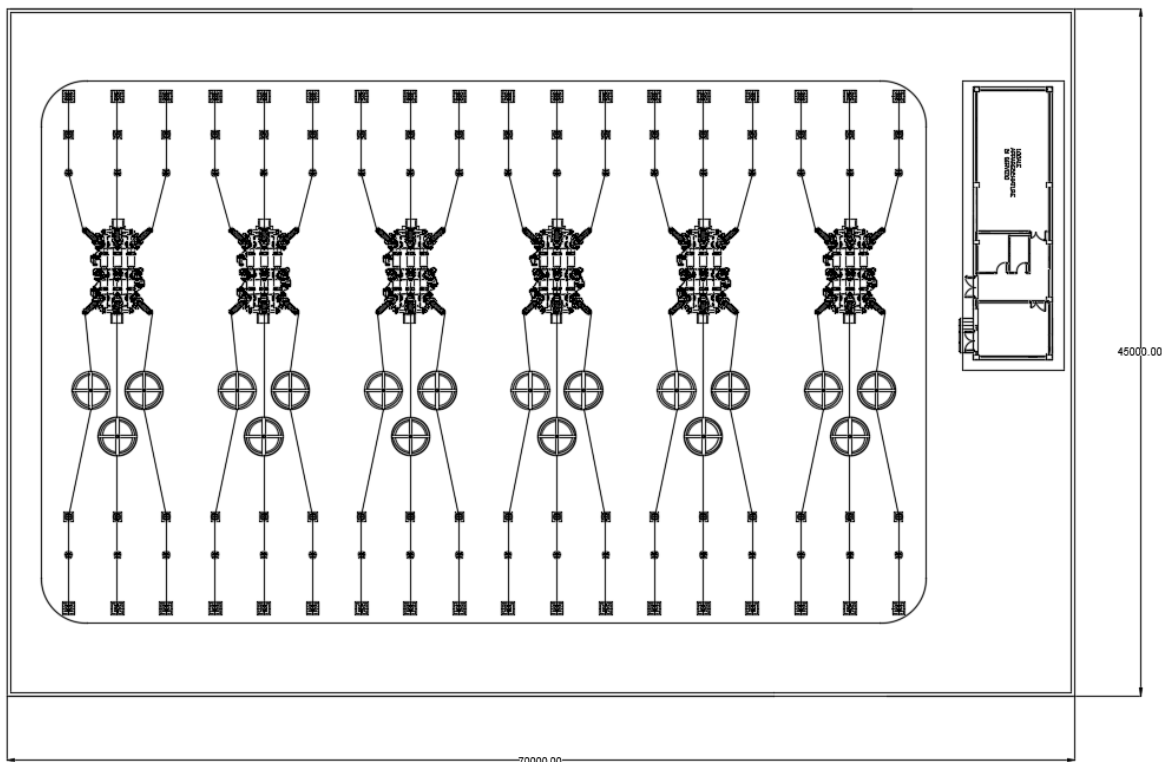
Vista in pianta della stazione di compensazione e sezionamento
